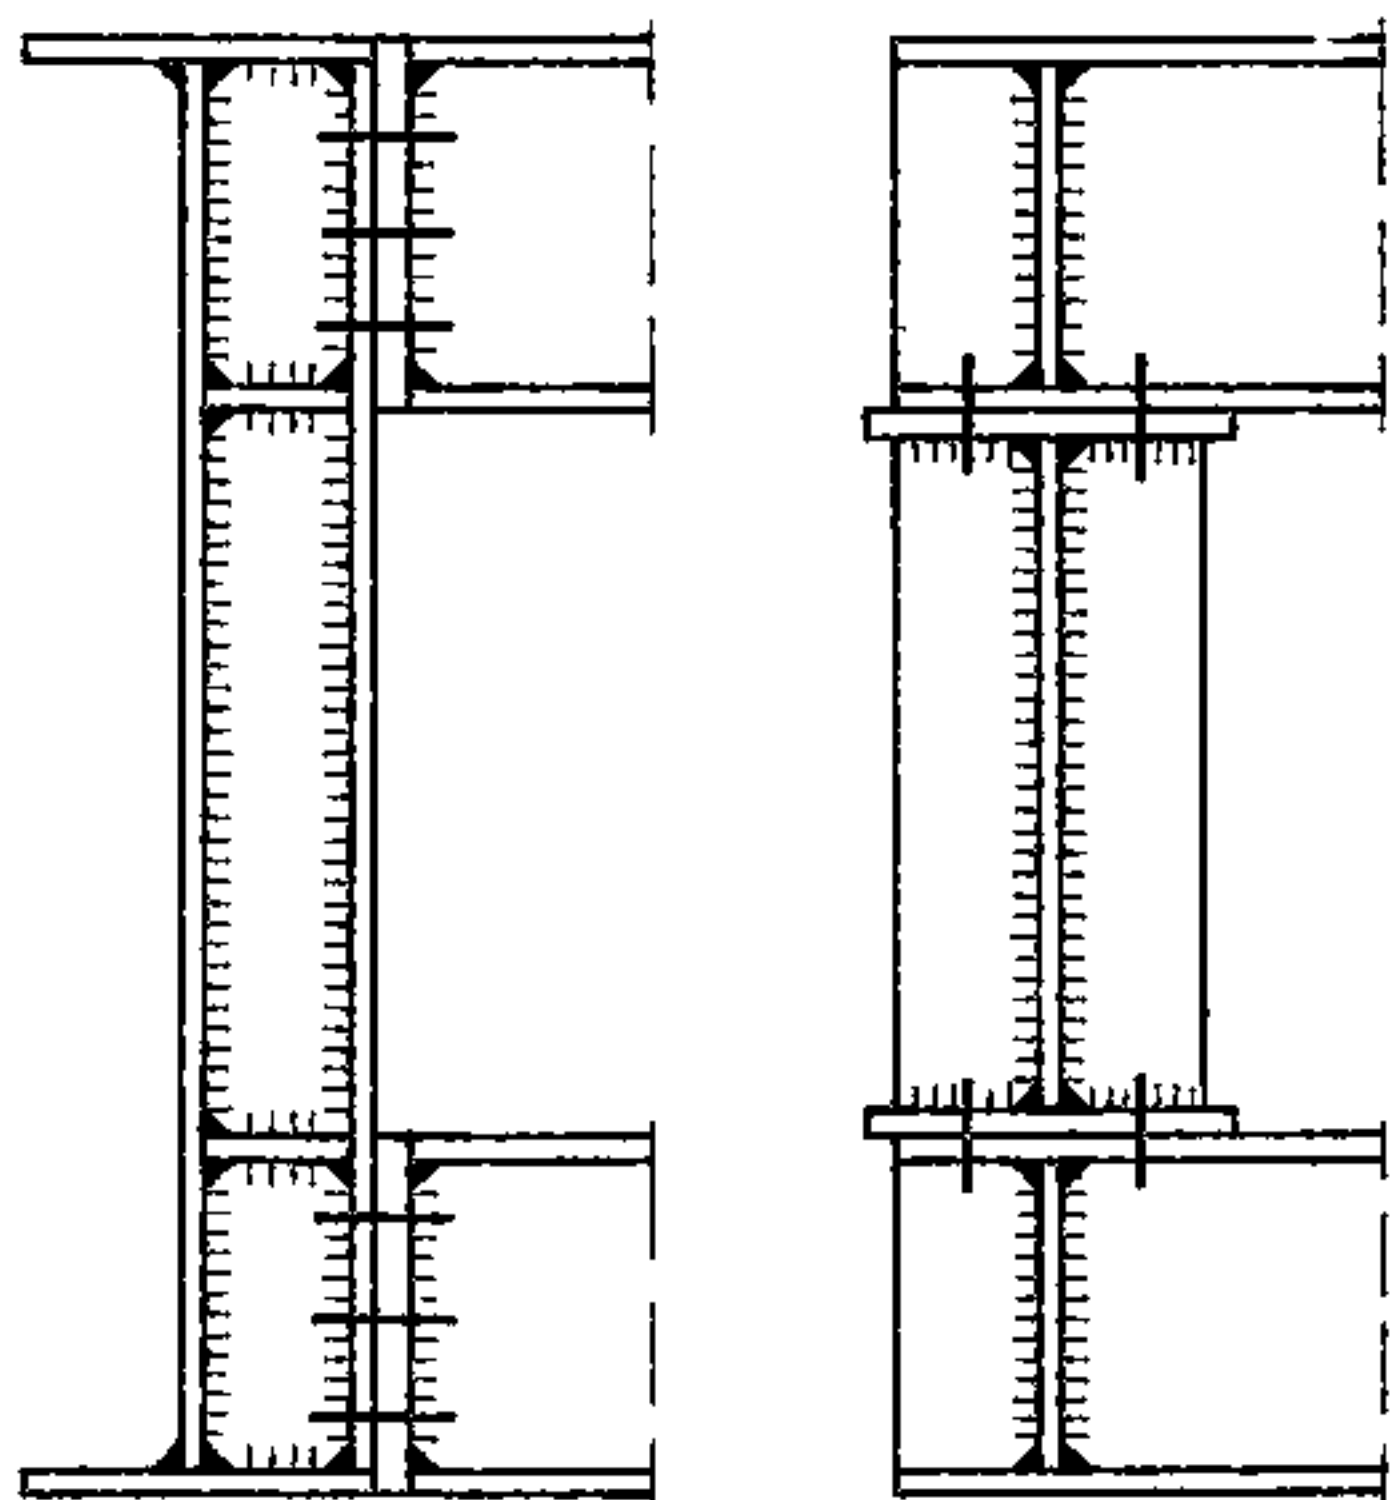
Узлы сопряжения балок покрытия и перекрытия с продольной балкой
